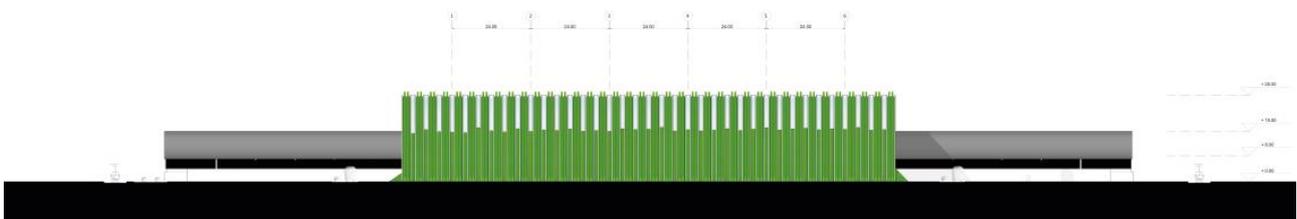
| Prospetto SudEst landside al 2035 con vista del Tetto verde da Viale Luder
